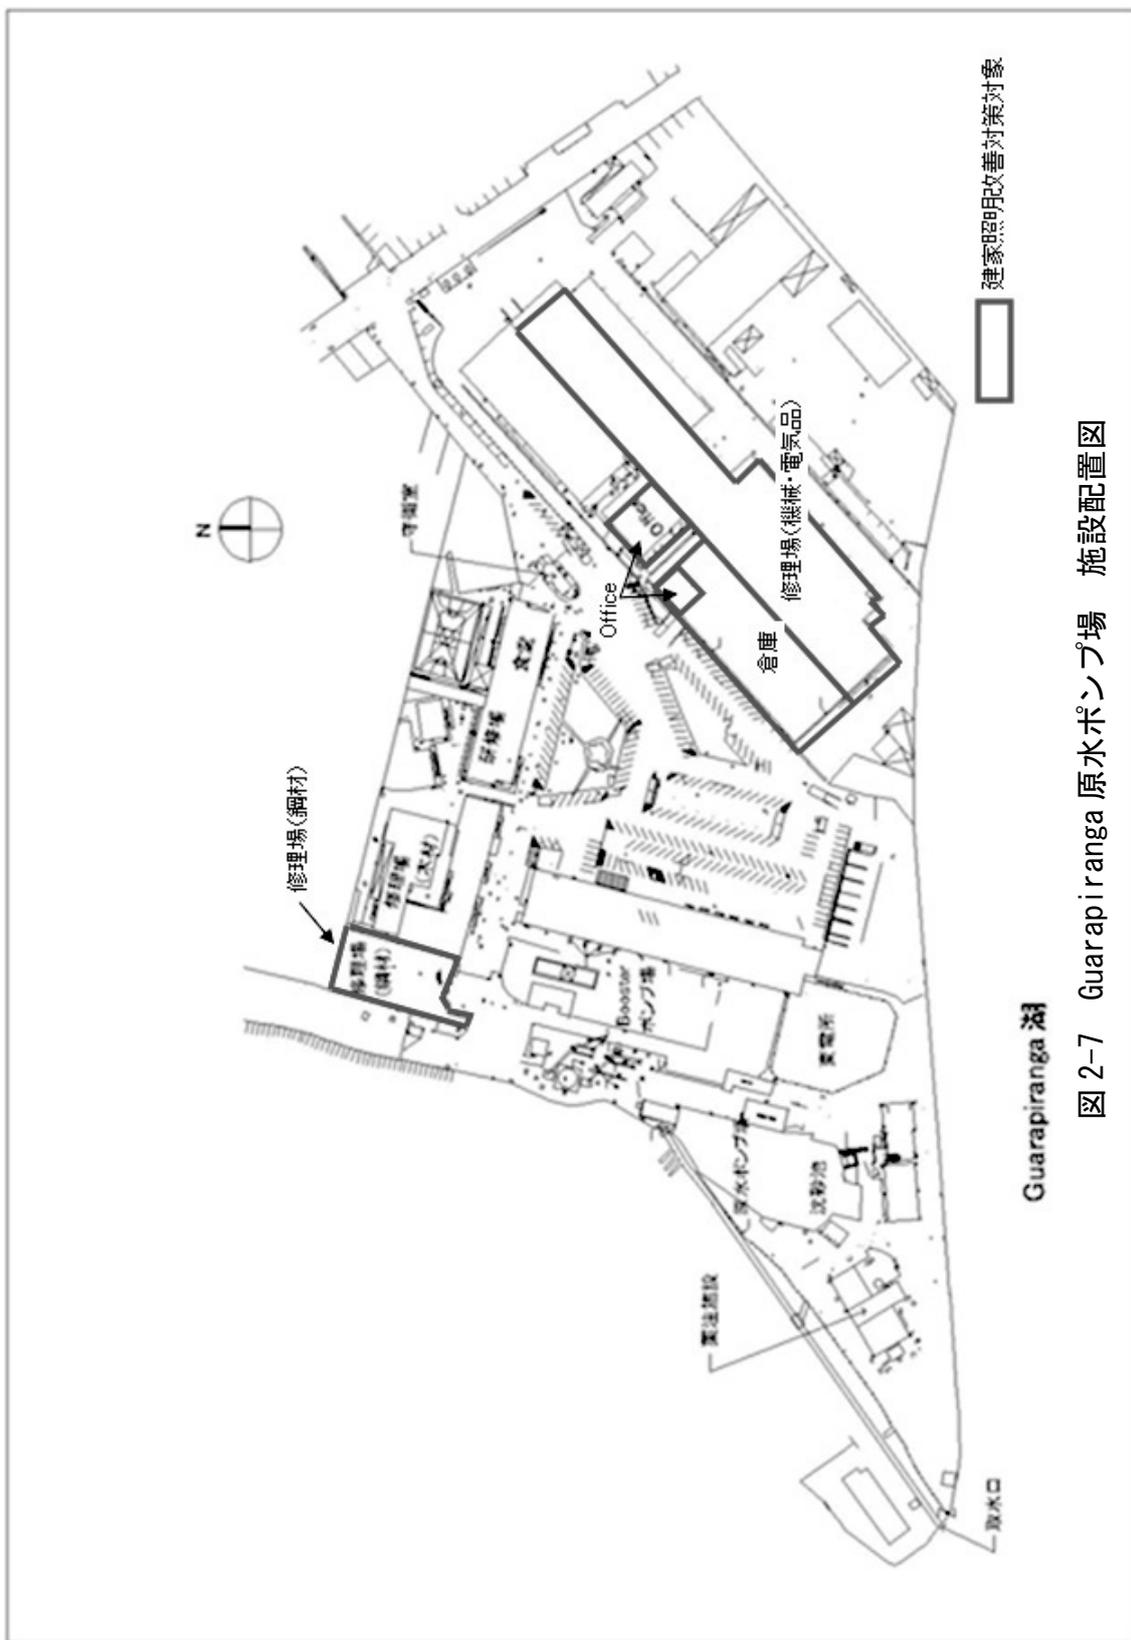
Guarapiranga 原水ポンプ場 施設配置図
